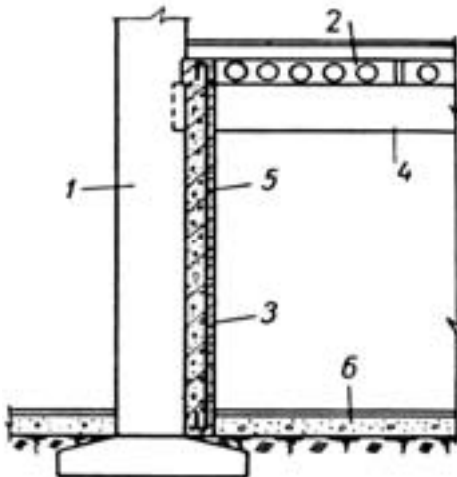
Підсилення зовнішніх стін шляхом обладнання додаткової стіни; 1 – існуюча стіна; 2 – існуюче перекриття; 3 – монолітний бетон; 4 – прогін підсилення перекриття; 5 – робоча арматура; 6 – бетонна підготовка підлоги.
